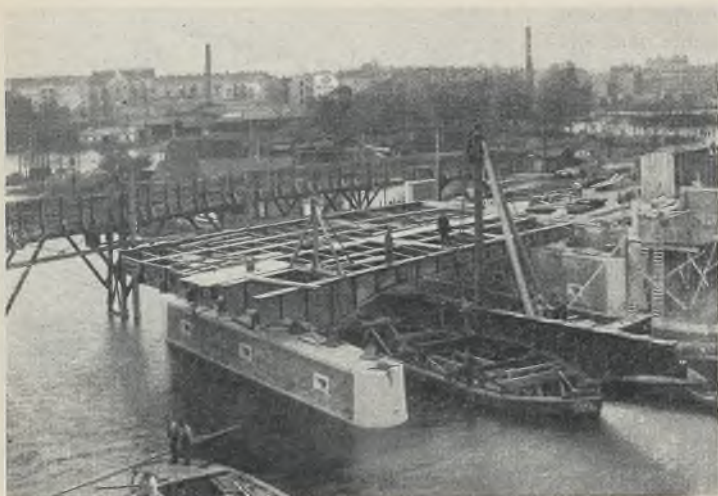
Billekanal-Brücke im Zuge des Billhornerdeichs; Montage.
